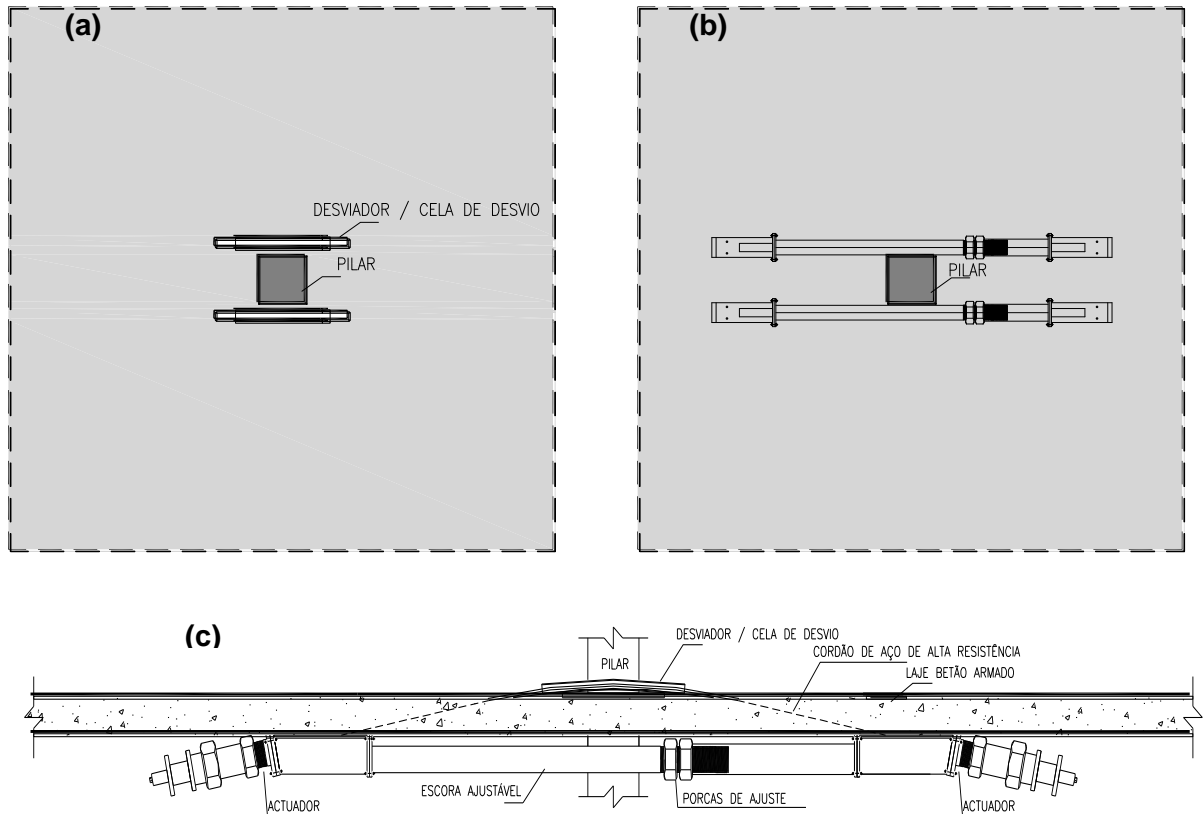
Aplicação do sistema no caso de pré-esforço unidireccional com actuadores tipo A, (a) vista superior, (b) vista inferior e (c) vista lateral.
